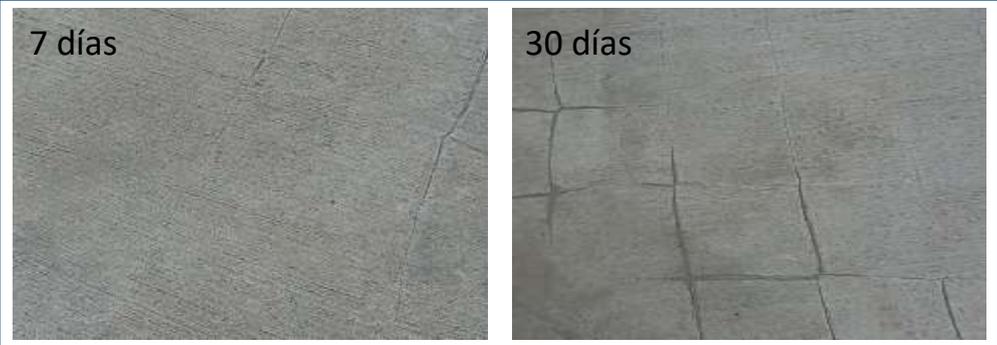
Fotografías pavimento terminado, a los 7 y 30 días posteriores al hormigonado
